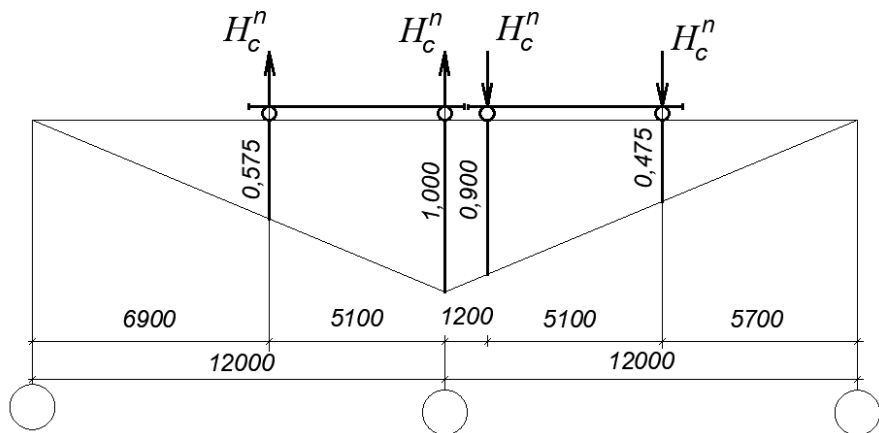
Схема для визначення горизонтальних кранових бічних навантажень від двох зближених кранів на середню опору за першим рекомендованим варіантом для лівої сторони крана
